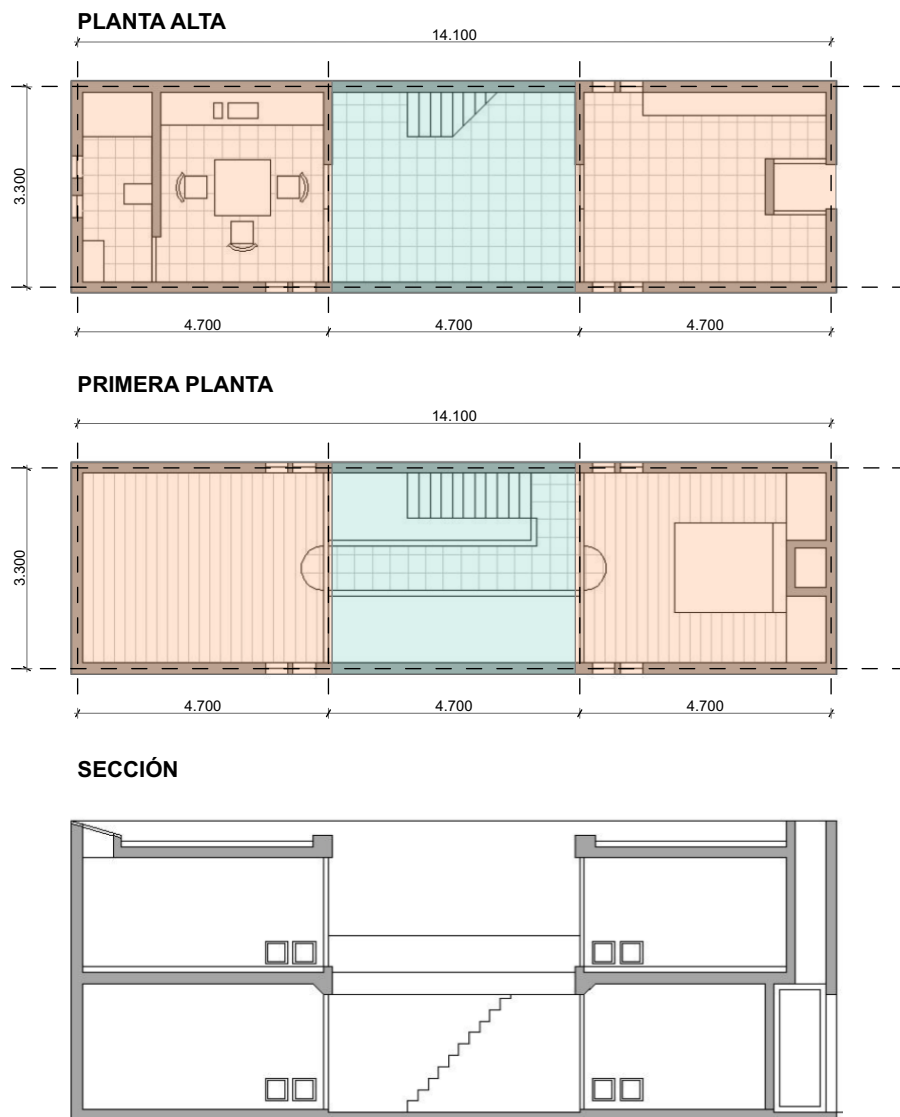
Plantas y Corte de la Casa Azuma, Tadao Ando. Fuente: Bueno, R. (2013). *Introducción a la arquitectura*.
